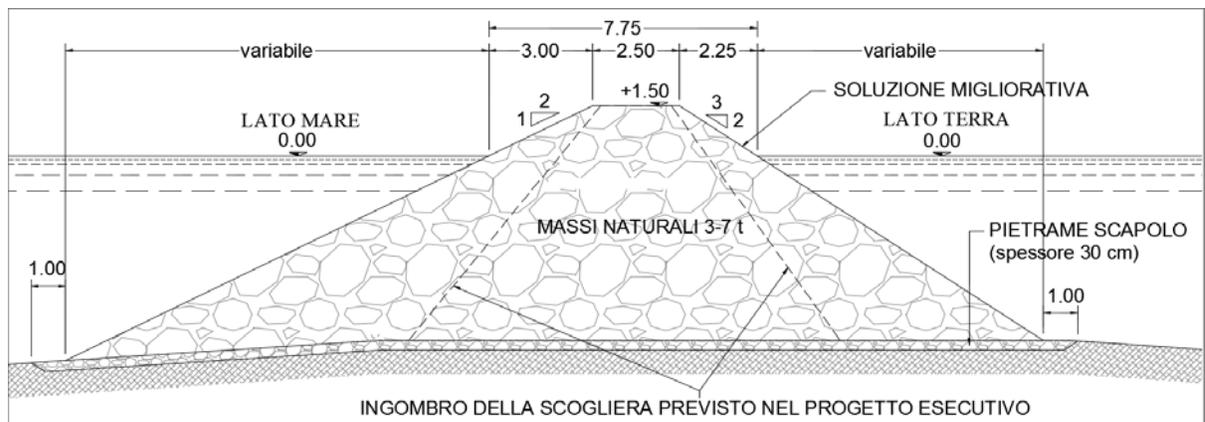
Sezione tipo scogliera emersa di progetto
